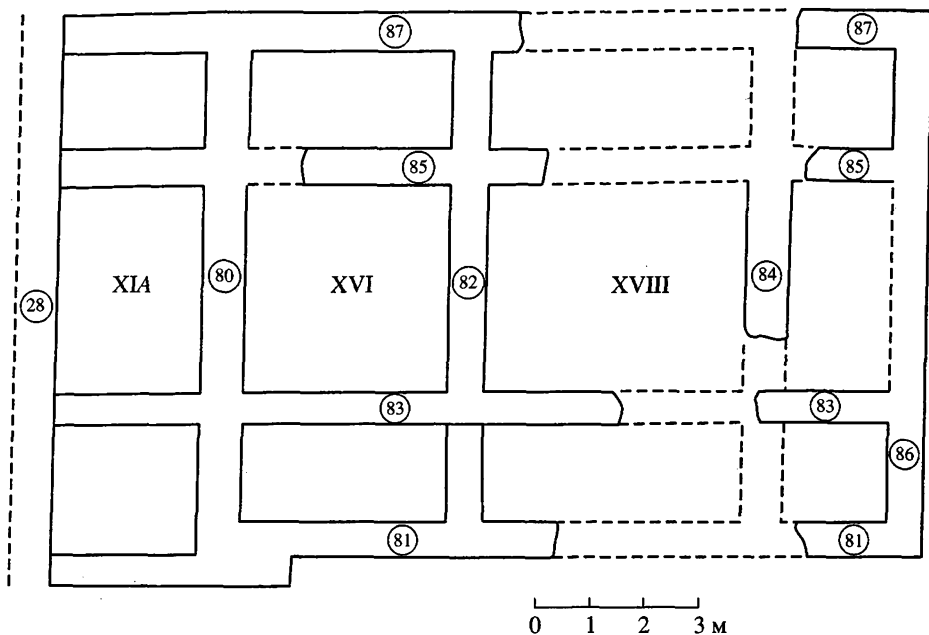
План здания первого строительного периода на пересечении главных продольной и поперечной улиц цитадели по И.А. Антоновой
